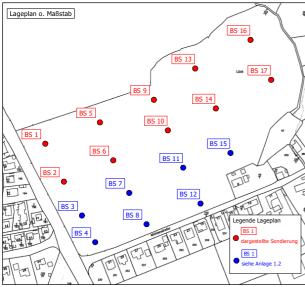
Lageplanausschnitt s. Anl. 1.1 (o. M.)
